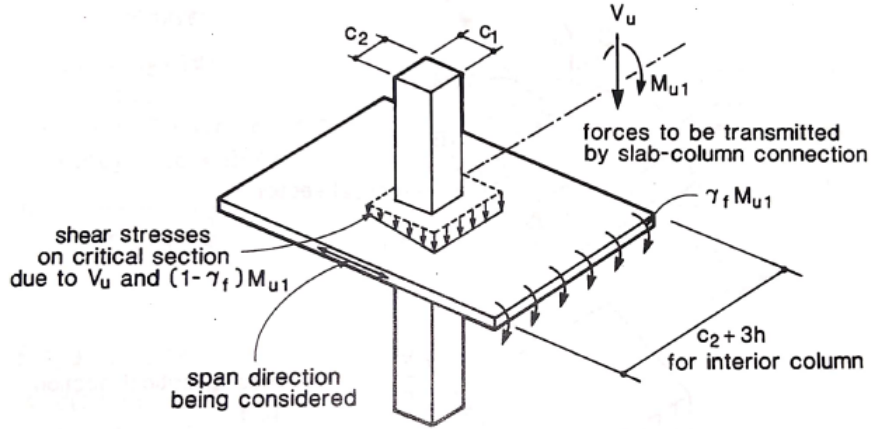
Transferencia de momentos en conexión losa-columna [18]
